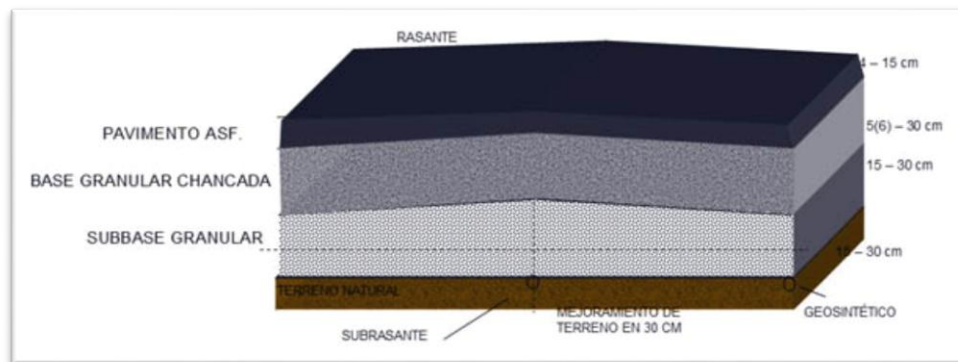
Pavimento Flexible (Asfalto)³
